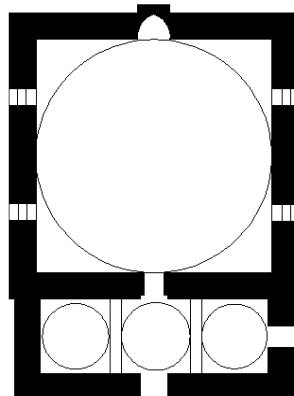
مخطط مسجد جناح - عن سرجنت.
